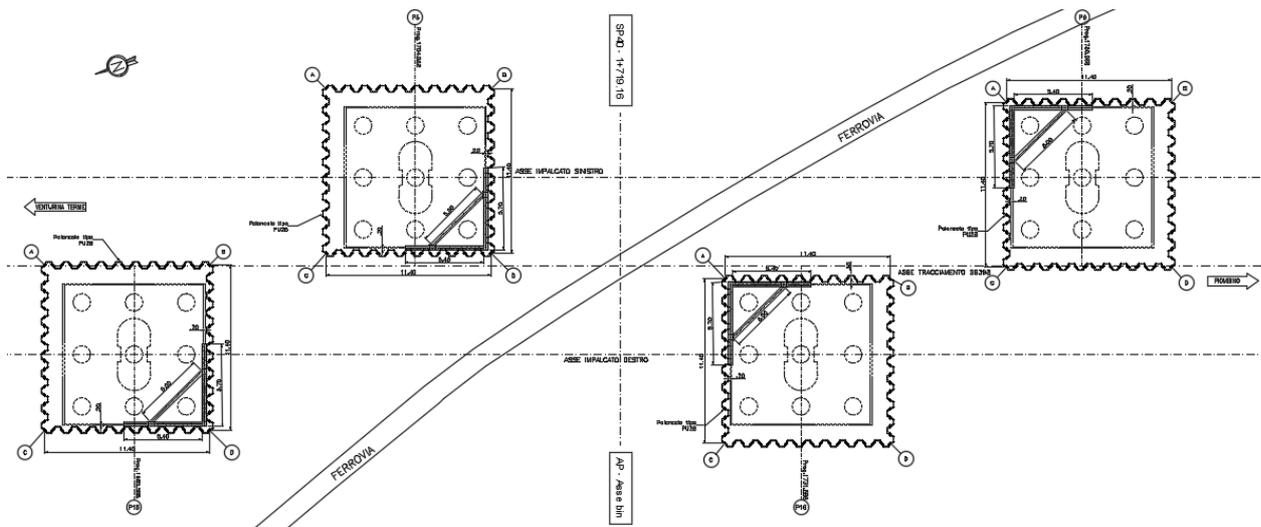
Vista planimetrica della ferrovia che corre in adiacenza alle pile P05, P06, P15 e P16.
